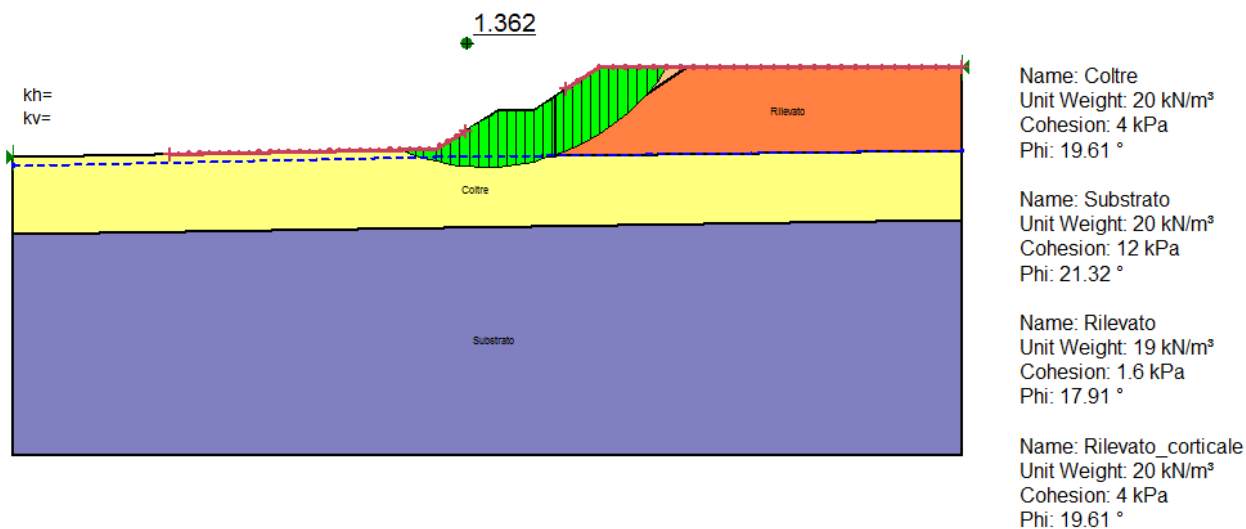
Sezione I; condizione statica. Verifica di stabilità globale.
